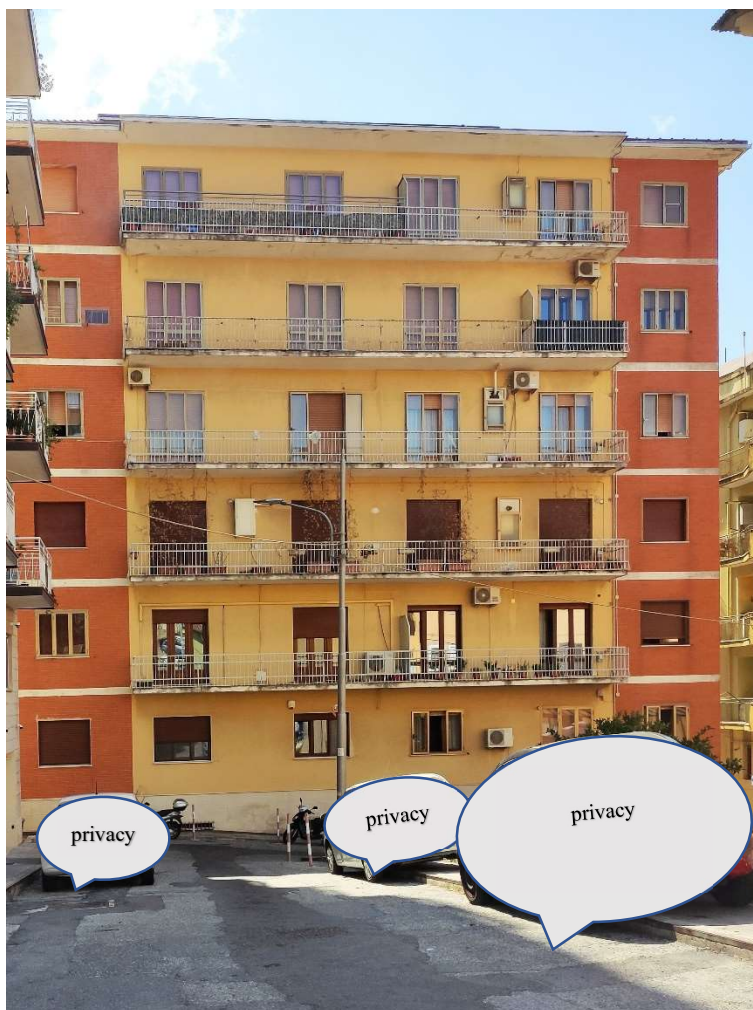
Vista edificio via Purificato 18. Nel complesso in buone condizioni. Abbisogna di interventi sui balconi e sul cornicione
